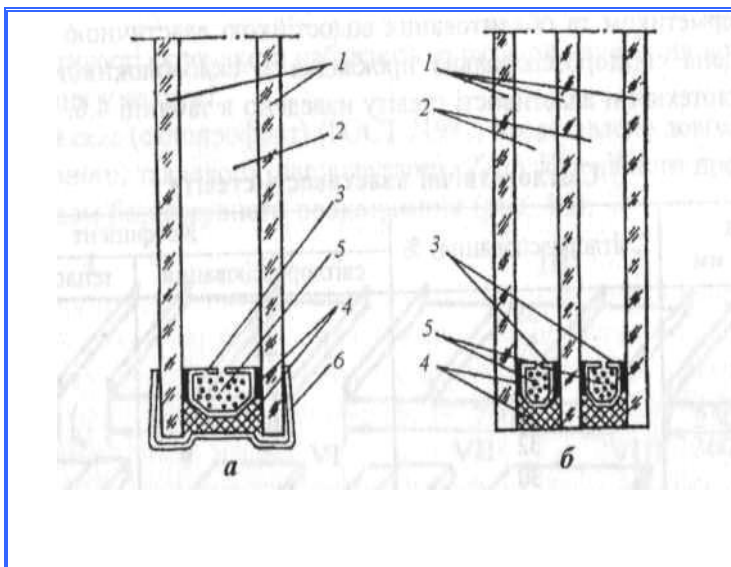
Конструкції склопакетів: а – двошарових (однокамерних); б – тришарових (двокамерних): 1 – скло; 2 – повітряні порожнини; 3 – металева рамка; 4 – герметик; 5 – осушувач; 6 – обкантировка.
